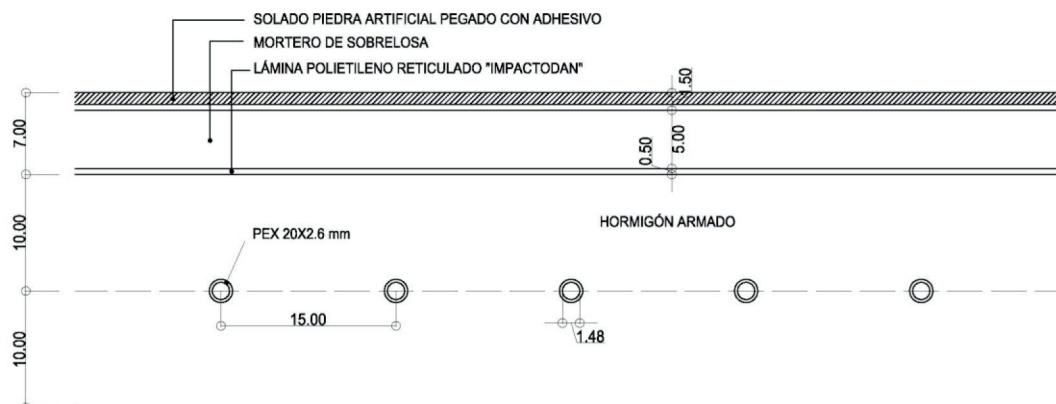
Detalle de losa activada térmicamente. Cotas en cm
